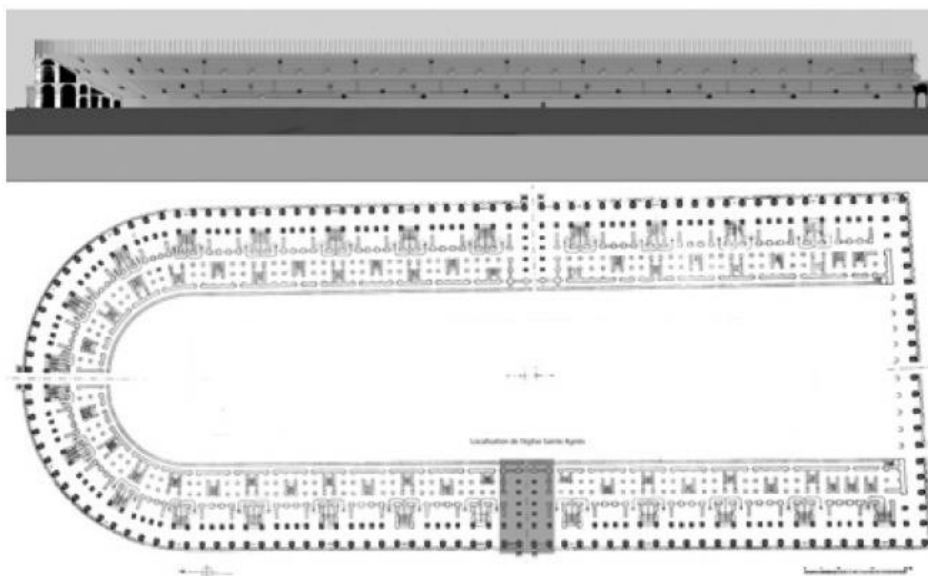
Plan orienté du stade de Domitien⁴⁸⁶
